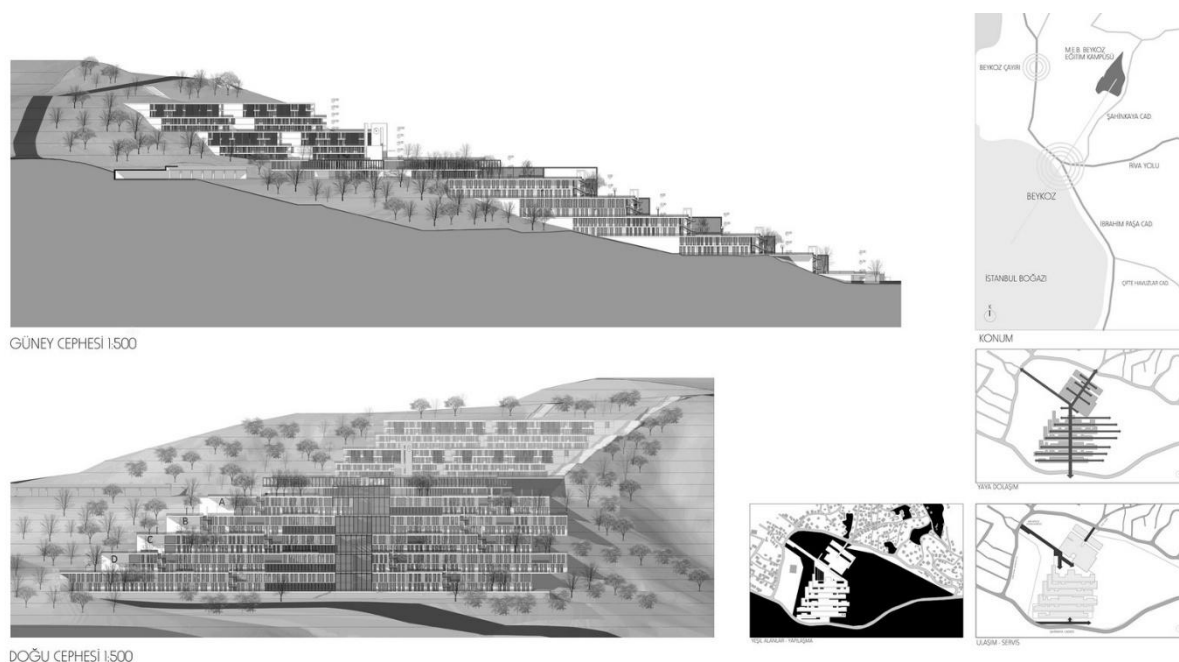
Planimetría. Fuente: Ziya Imren Architects
